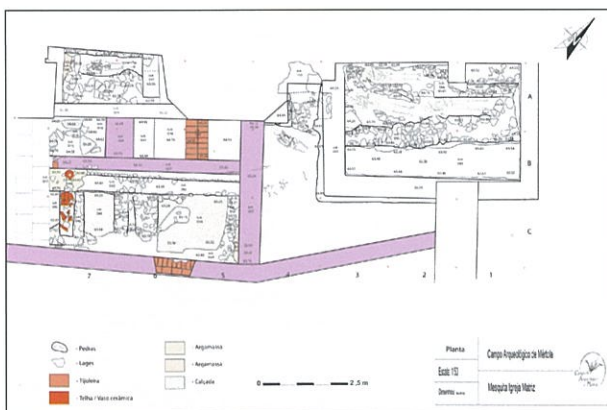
Planta de la excavación con la localización del osario y de las estructuras de las sacristías.
